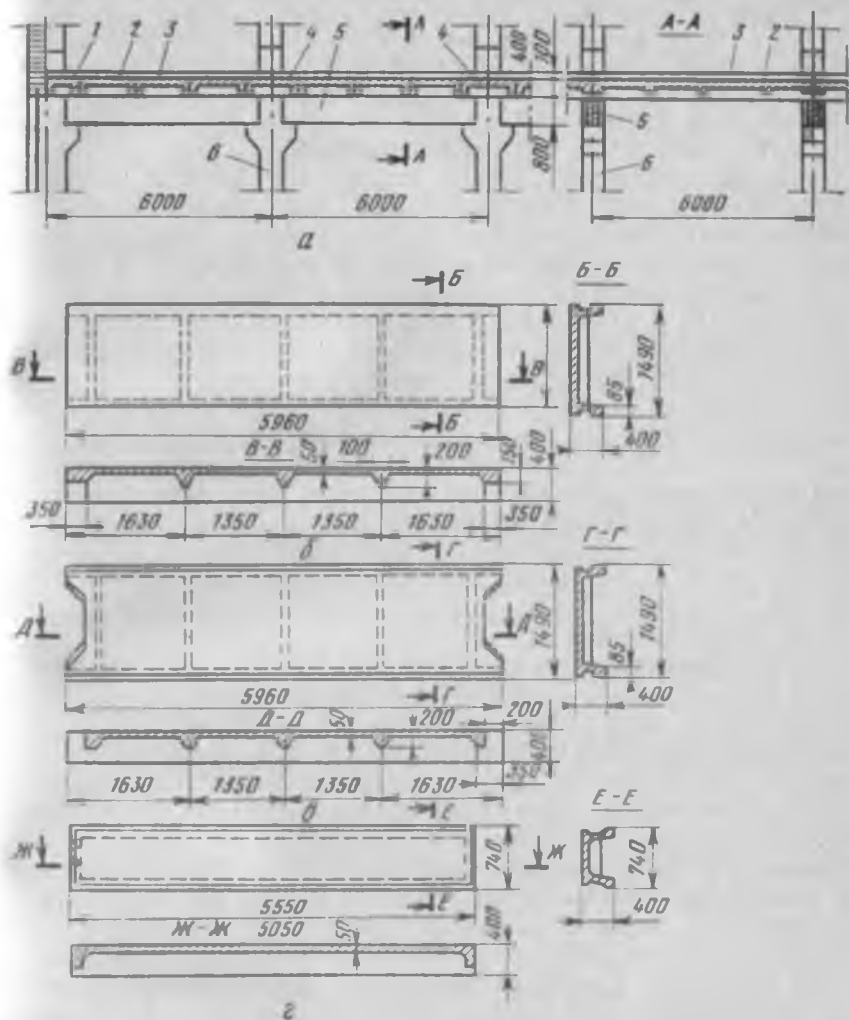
Детали конструкции сборного железобетонного перекрытия:
